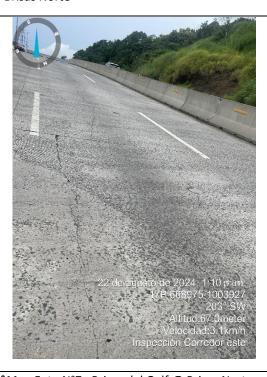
Foto N°7: Brisas del Golf @ Brisas Norte
